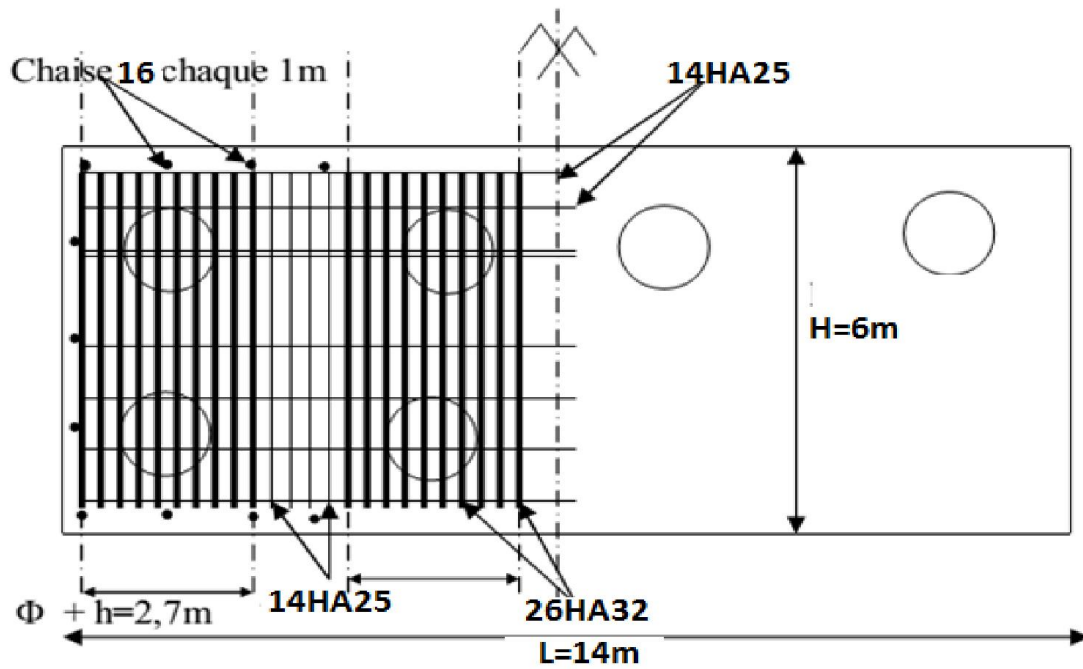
Ferrailage de la semelle (nappe inférieure).
